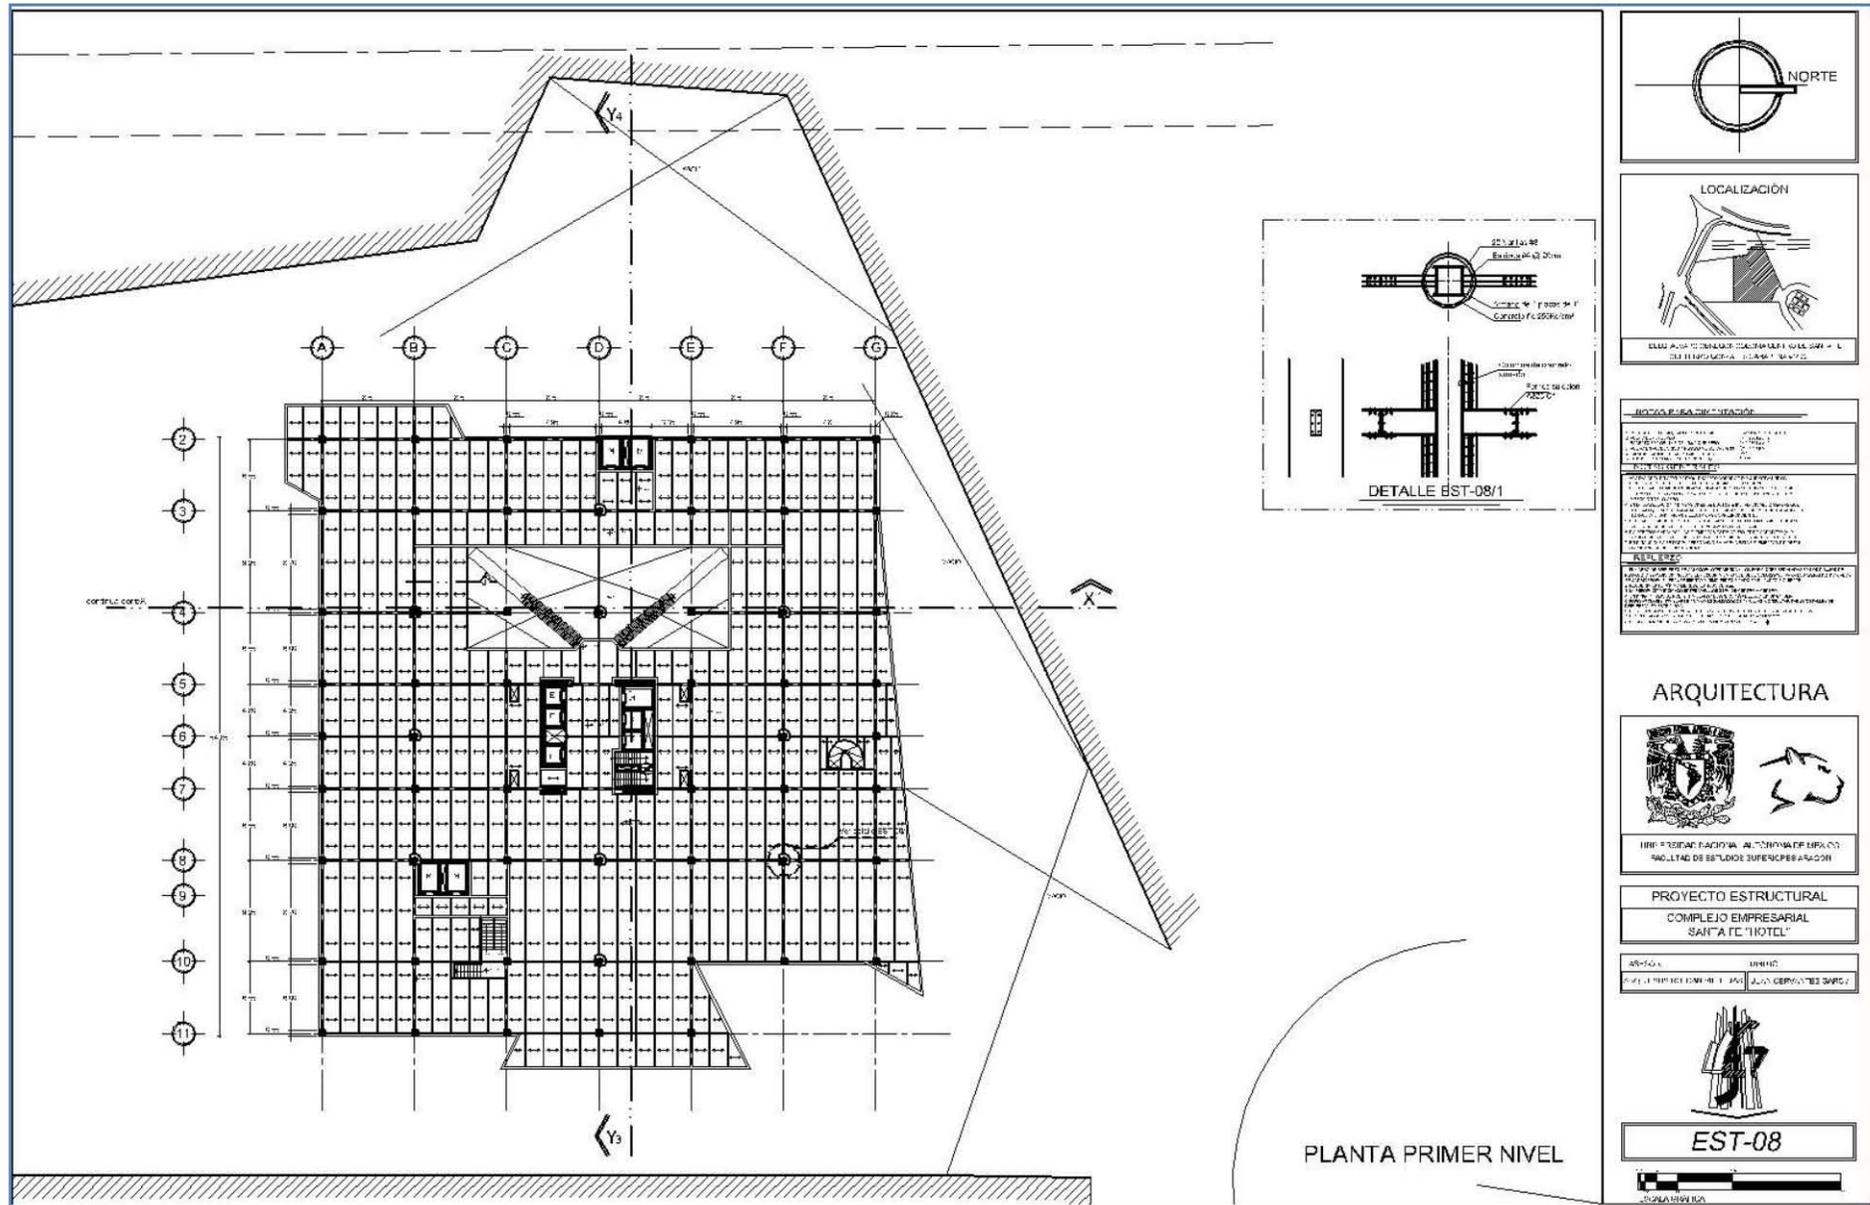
Plano Est-08; Disposición de losacero en primer nivel. Edición propia.
